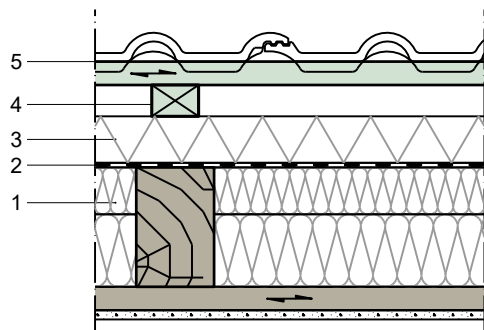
Dachaufbau mit erhaltenswerter Innenbekleidung und vorhandener Teildämmung
